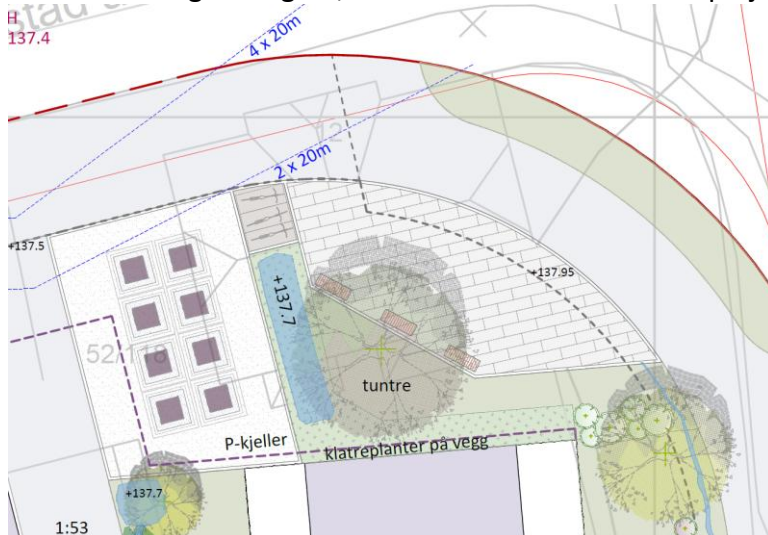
oversikten viser fordelingen av de ulike jorddybdene i de grønne arealene i planområdet (Østre Linje)
